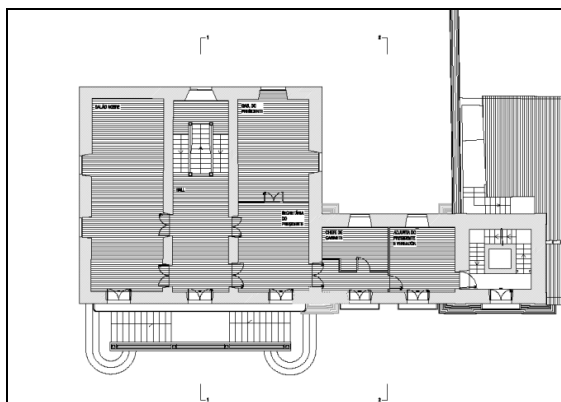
Casa de câmara e cadeia da Ribeira Grande – planta do terceiro piso.
